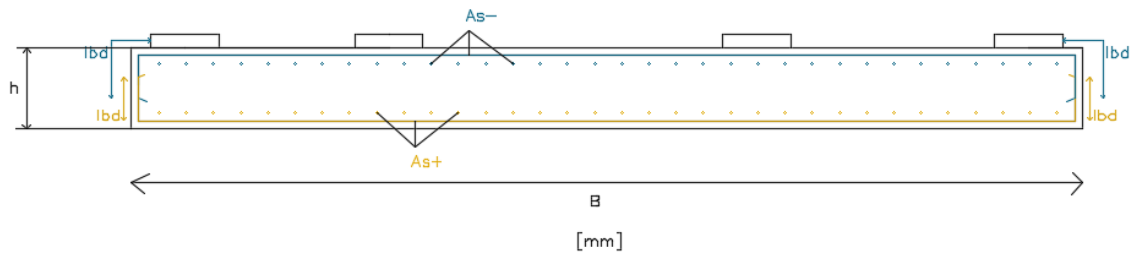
Pormenor da disposição construtiva da armadura longitudinal da fundação E
